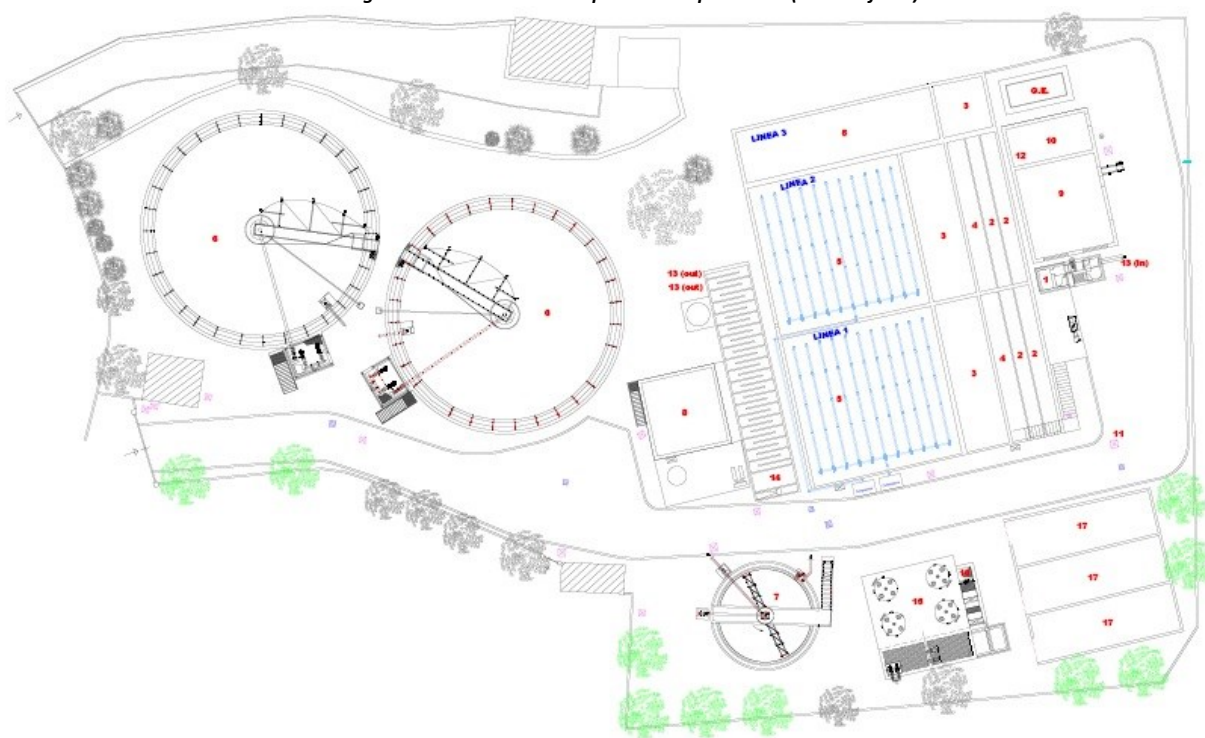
Planimetria dell'impianto di depurazione (stato di progetto)
